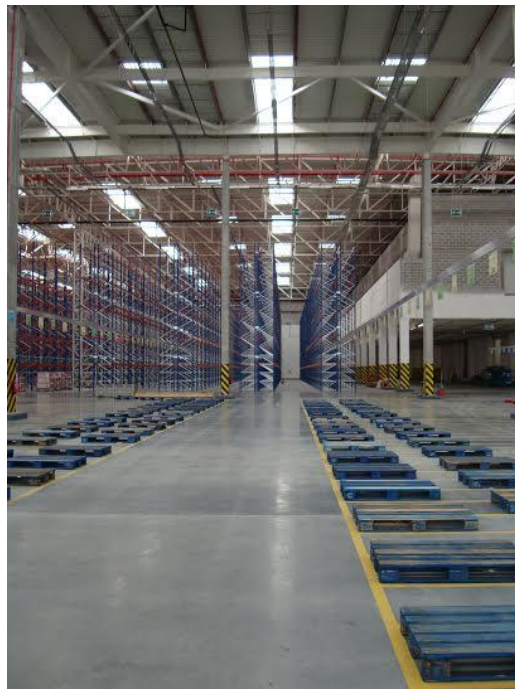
Exemplo de pavimento com aplicação de endurecedor com partículas metálicas.
